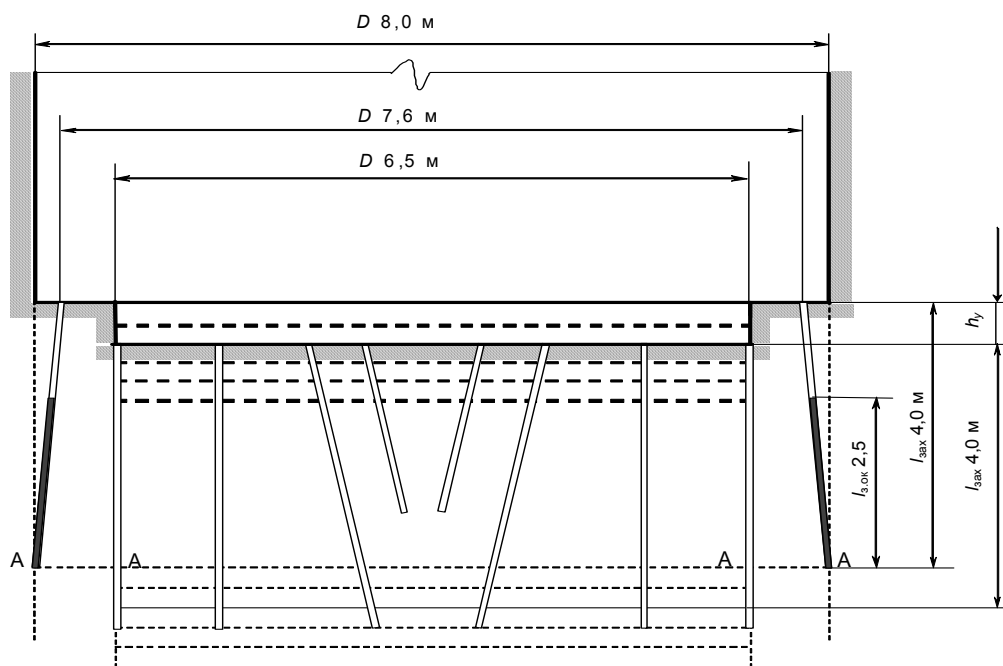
Предлагаемая схема расположения шпуров для условий проходки воздухоподающего ствола № 3 ШУ «Покровское»
